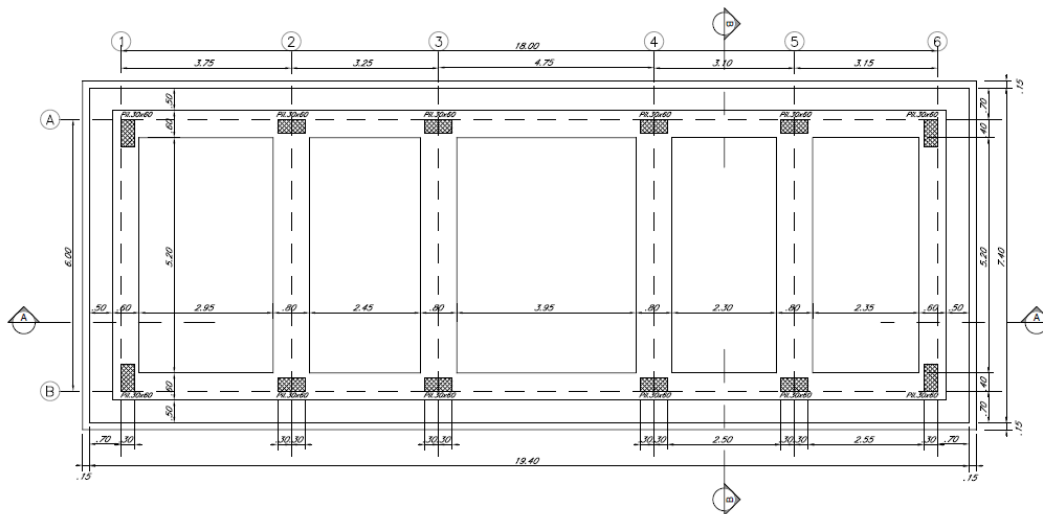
Carpenteria fondazione Fabbricato tipo A
